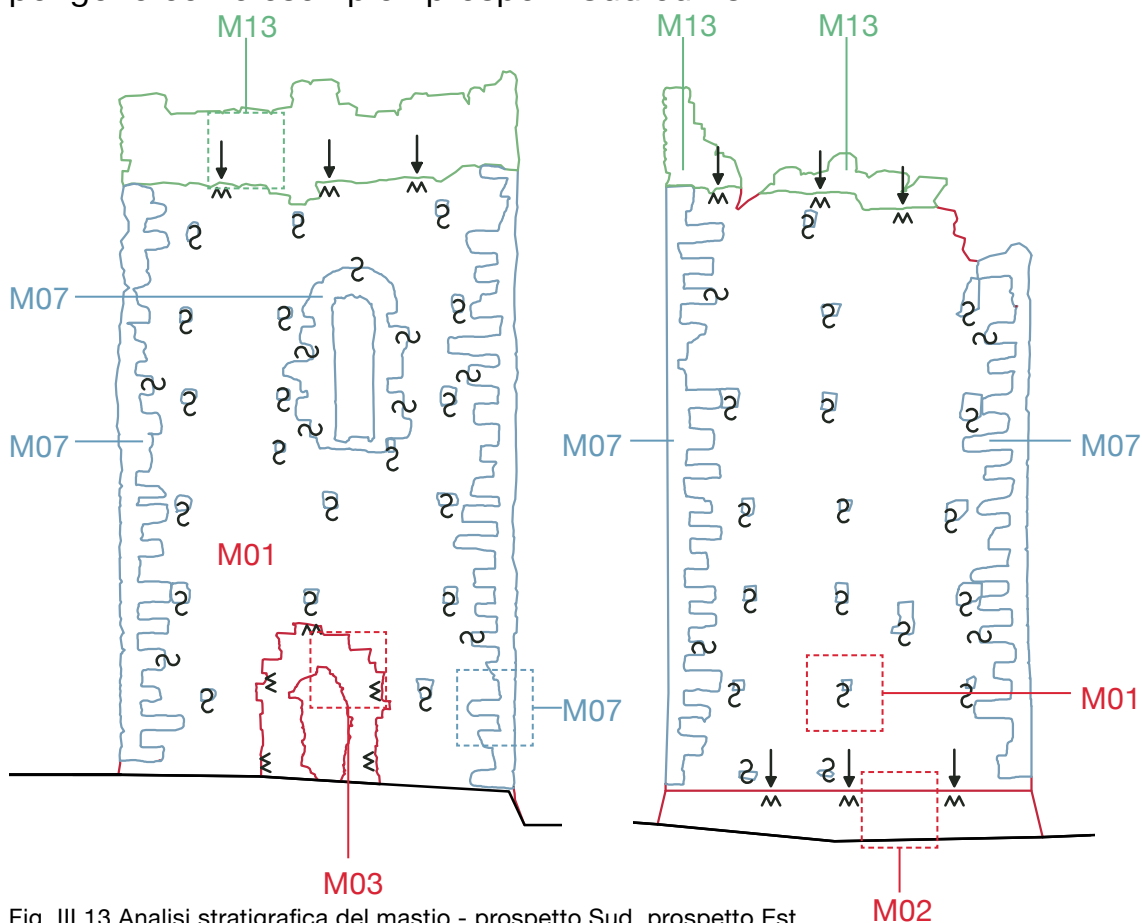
Analisi stratigrafica del mastio - prospetto Sud, prospetto Est.
